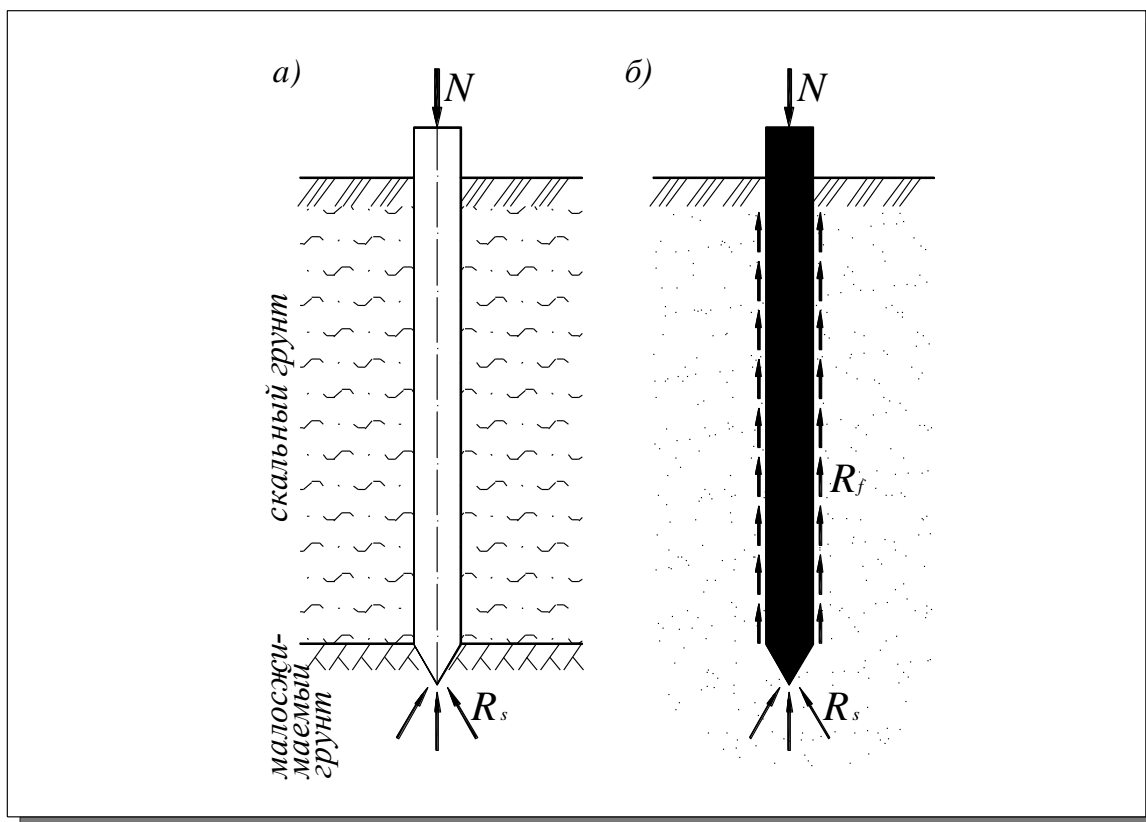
Схемы передачи нагрузки сваями на грунты основания:
